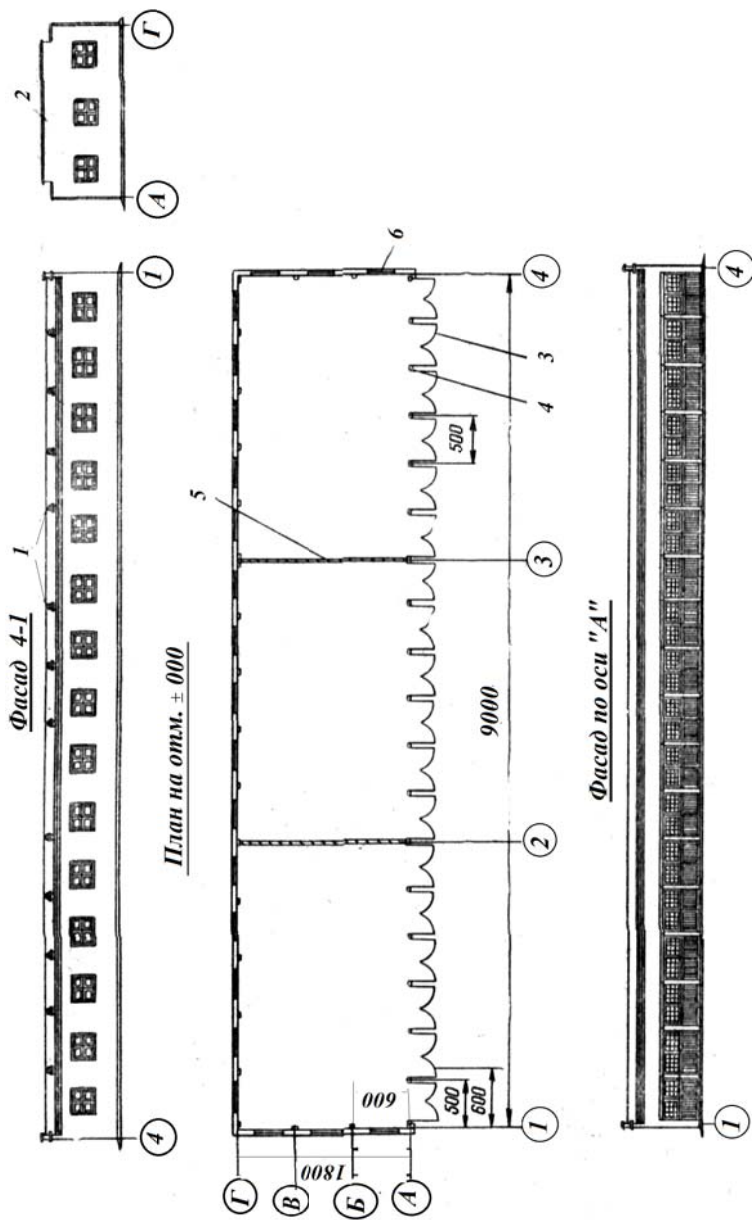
План и фасады отапливаемого хранилища на 36 машин.
